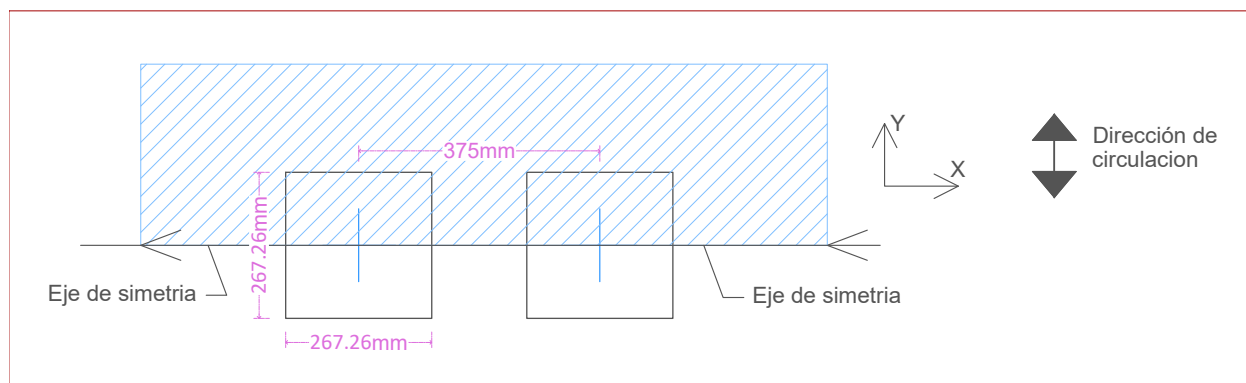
Huellas de las ruedas dobles y vista en planta del cuarto modelado de la calzada
